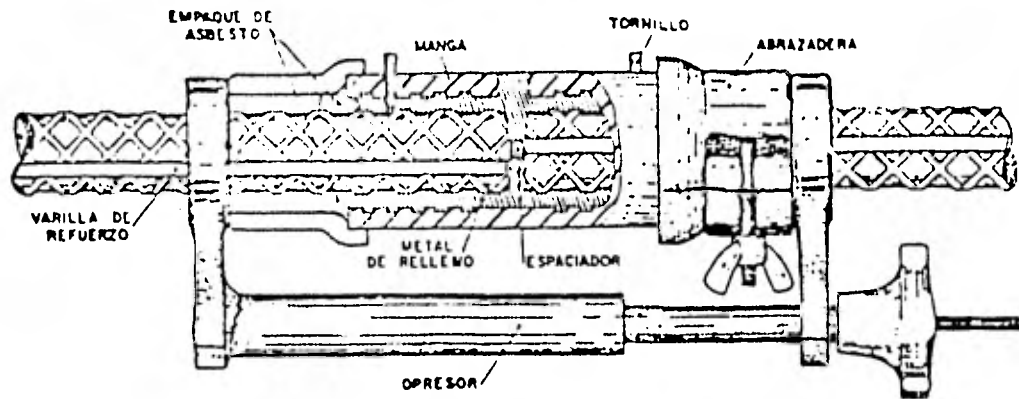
ELEMENTOS PARA LA FABRICACION DE JUNTAS CADWELD
